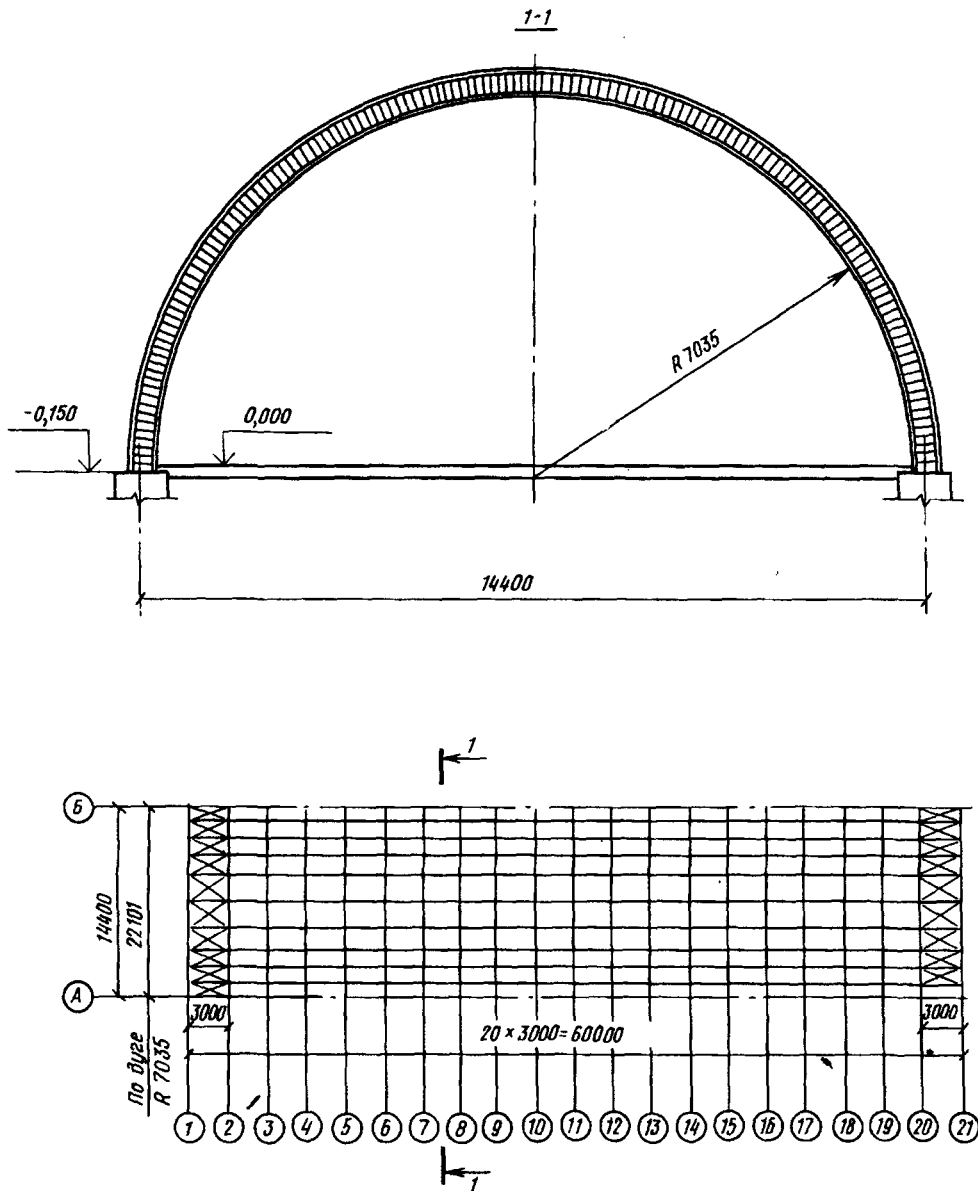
Арка сплошного сечения (поперечный разрез и план связей)
